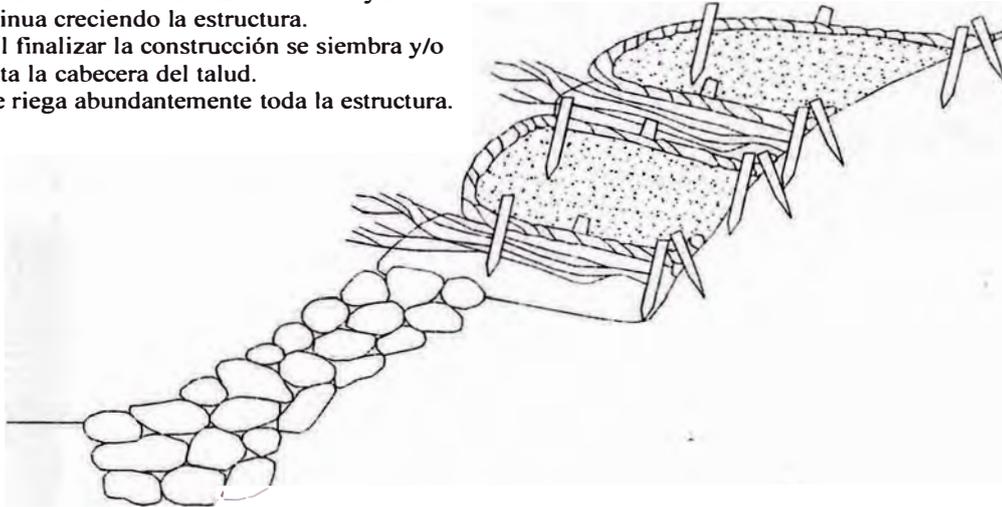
(f): Estructura de tierra reforzada – Proceso Constructivo
